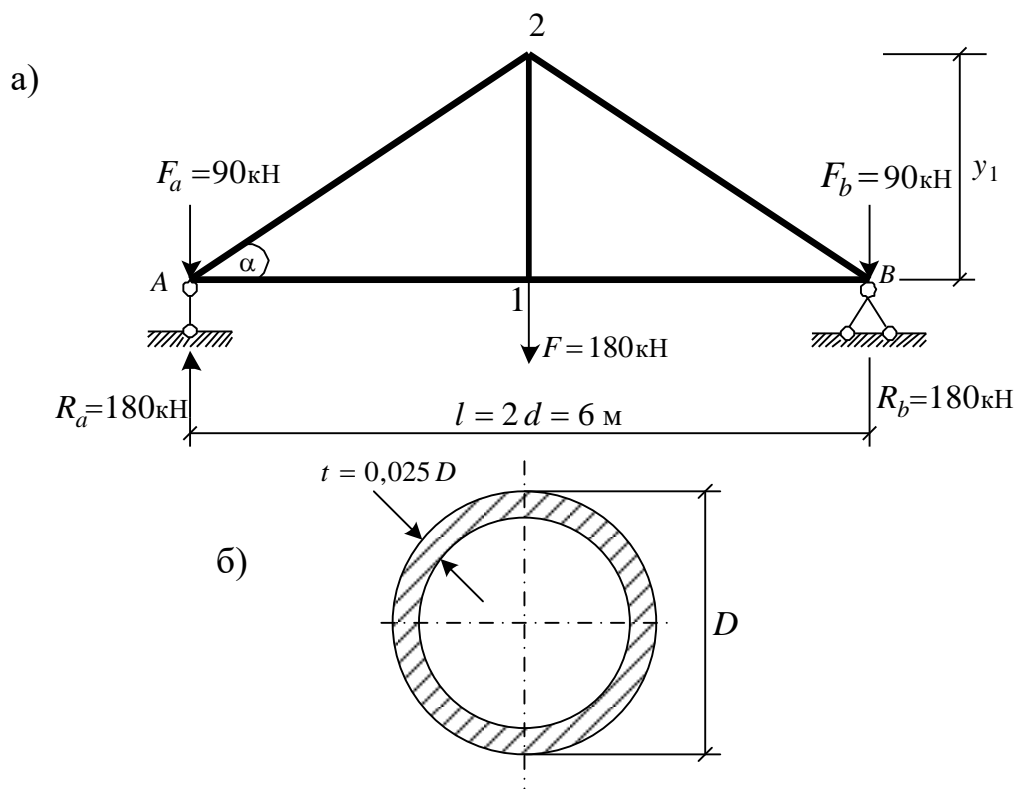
Ферма: а – расчетная схема, б – трубчатое сечение стержня фермы
